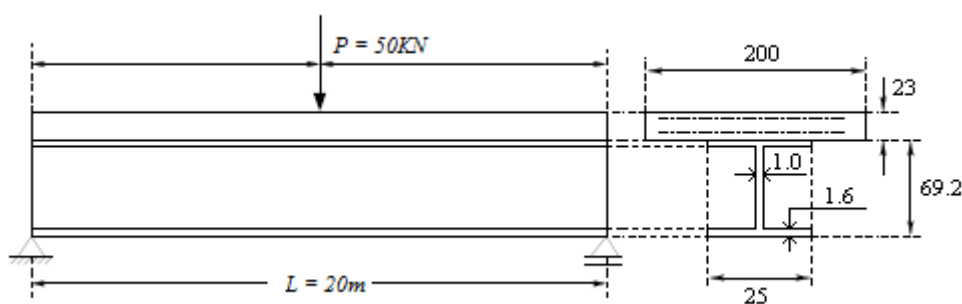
Viga mista aço-concreto e seção transversal (cotas em cm)
